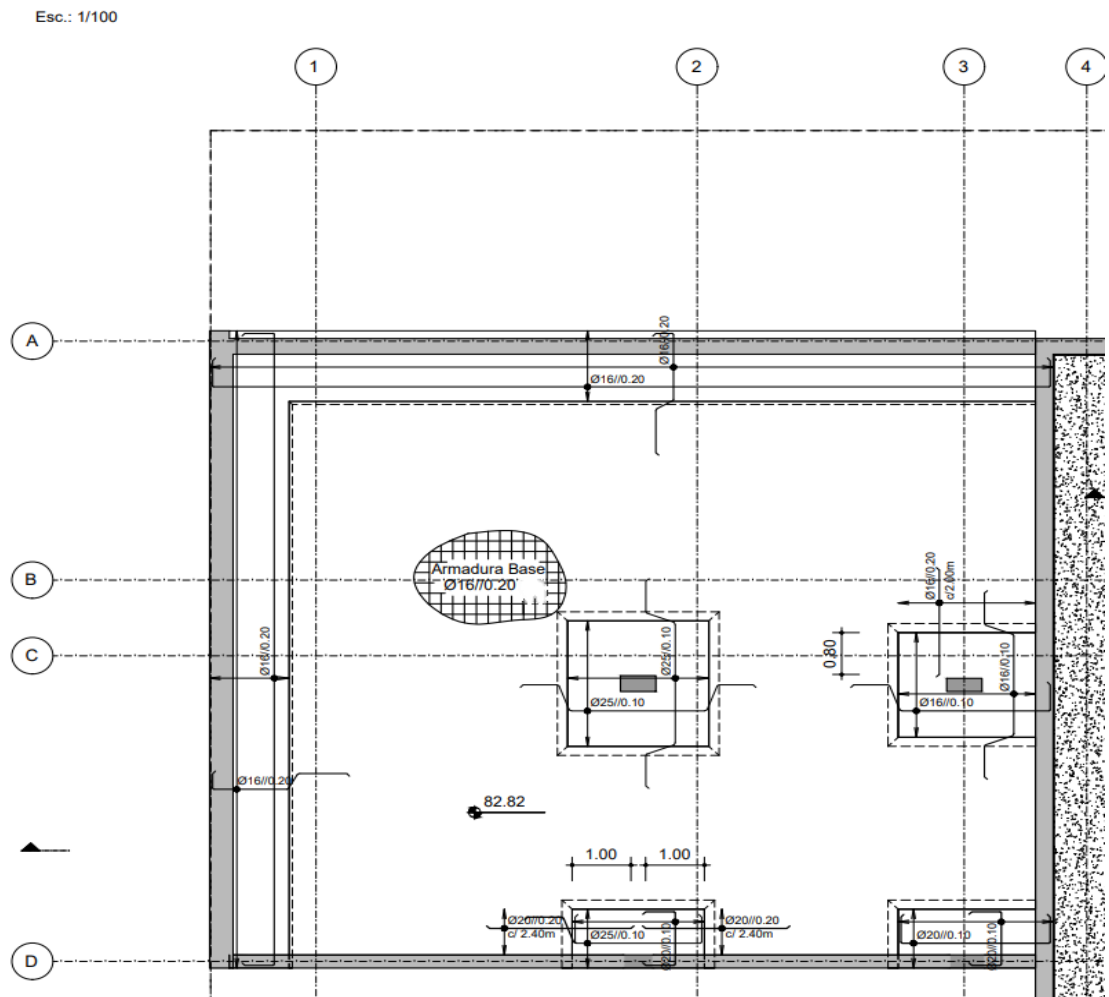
Planta de armadura inferior do ensleiramento.
